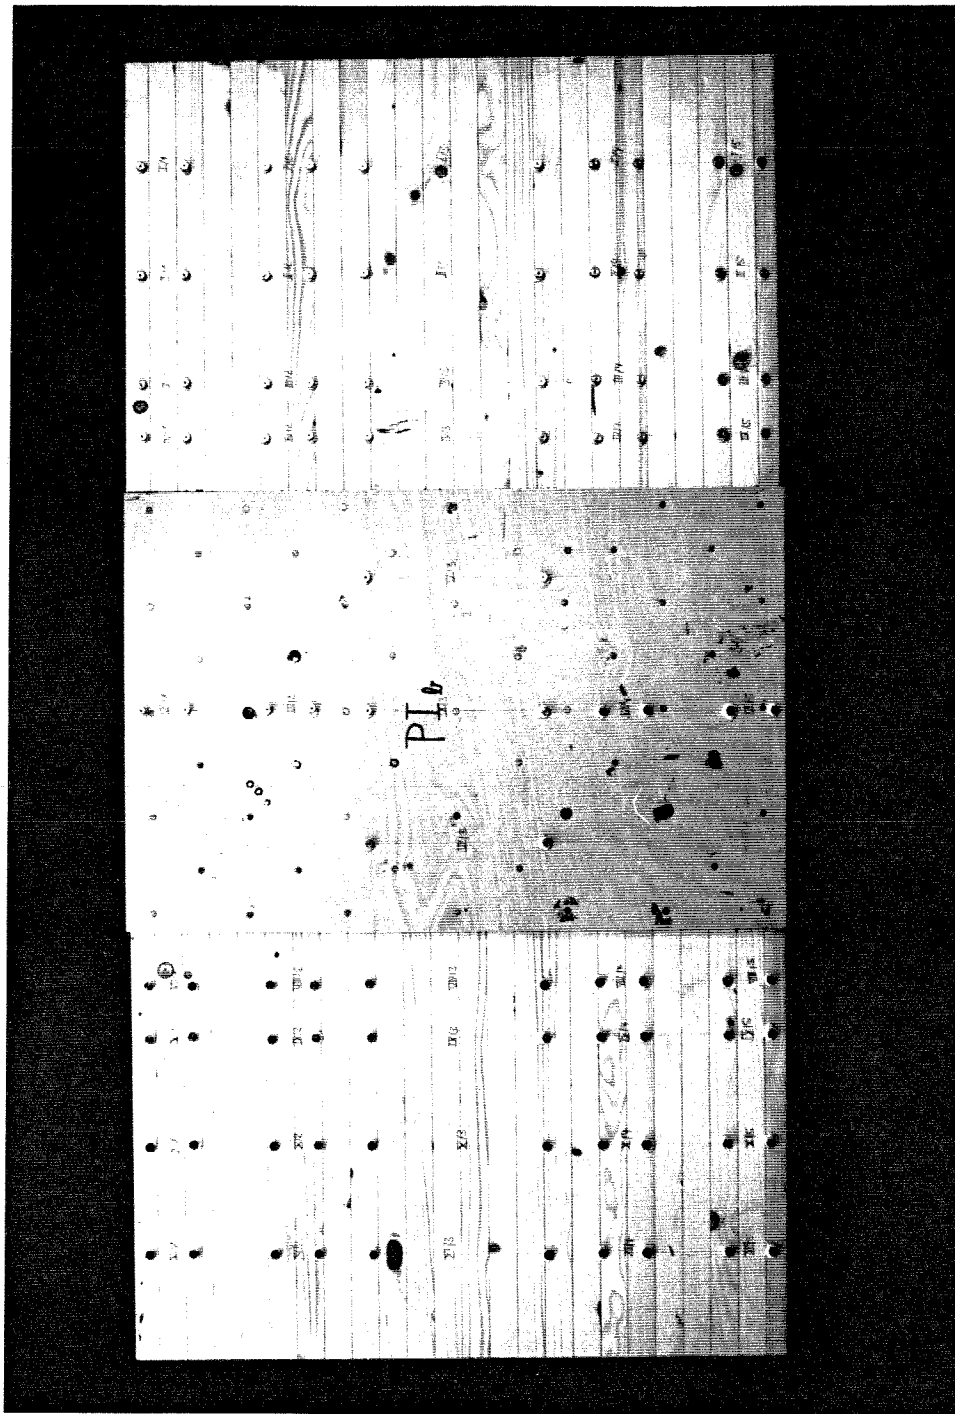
Seitenansicht des beplankten Prüfkörpers Ib
